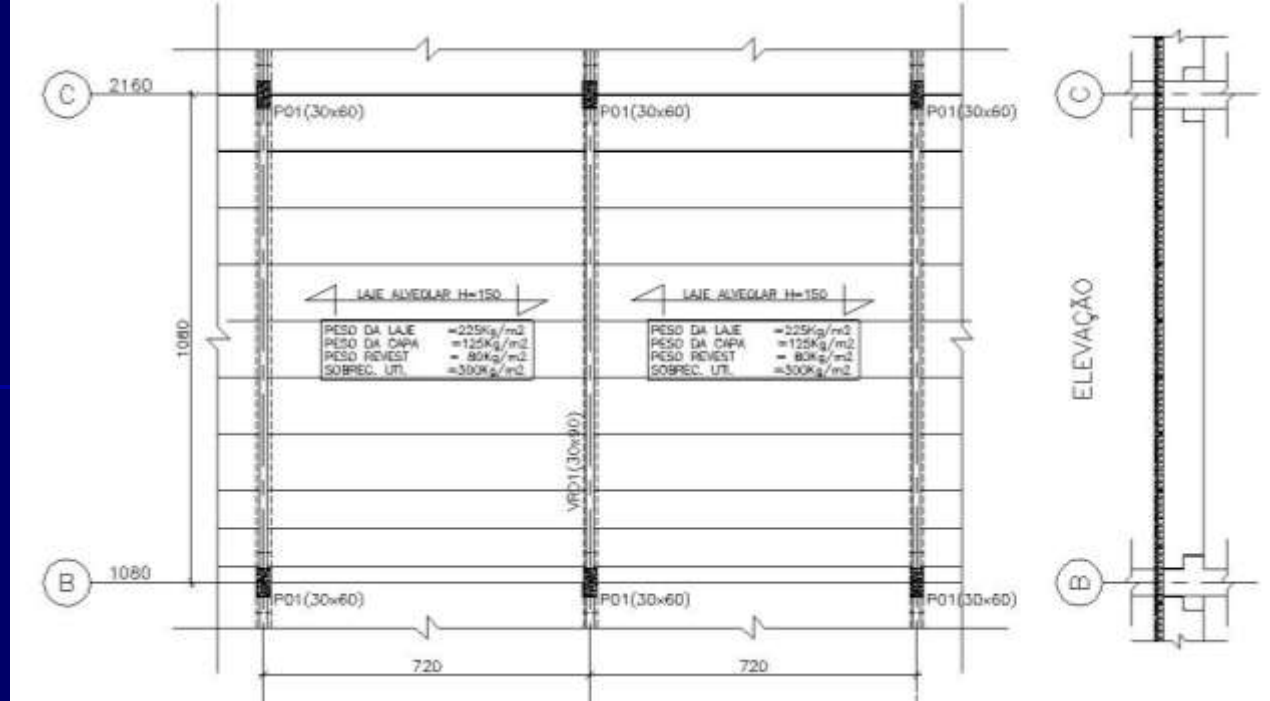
Planta do pavimento e elevação da viga VR01 (unidades em cm)
